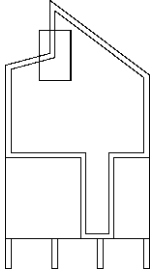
| Detail Dachanschluss. Hand|Werk|Raum. M1:20.
